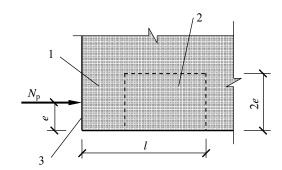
防止沿孔道劈裂的配筋范围 1-局部受压间接钢筋配置区; 2-附加配筋 区; 3-构件端面
